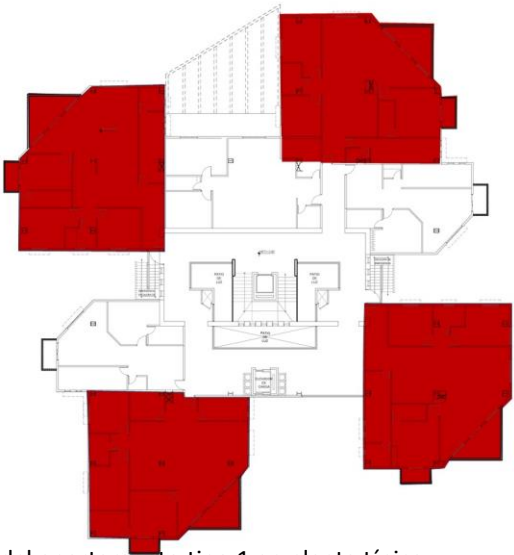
Ubicación del apartamento tipo 1 en planta típica
